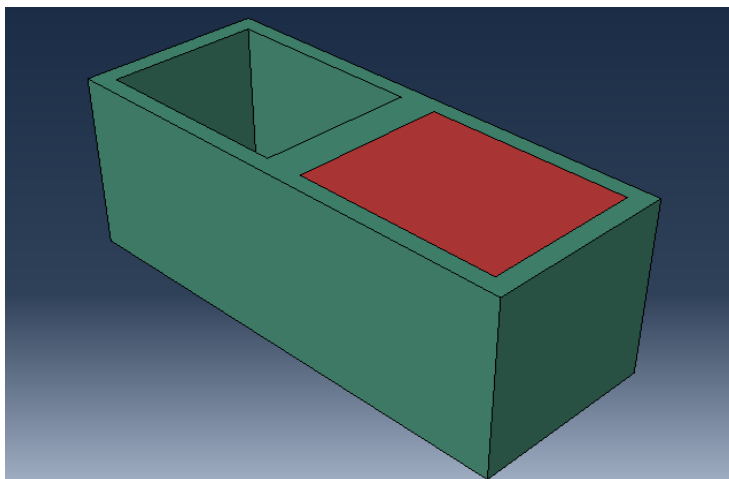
Blocco in calcestruzzo (verde) con grout (rosso)
